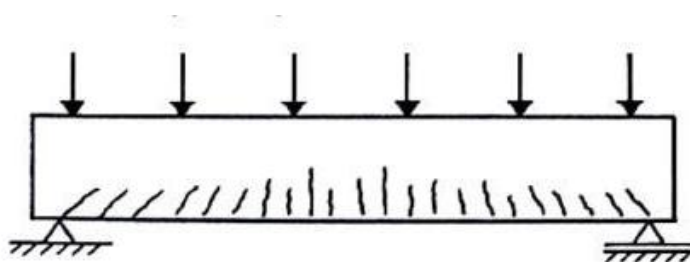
Fissuras por flexão (THOMAZ, 2003).
